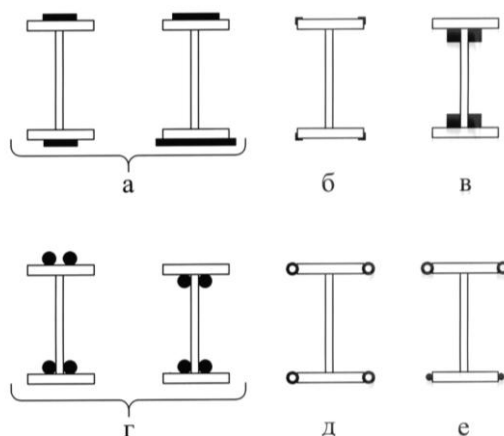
Усиление стальных балок симметричными накладками из: а – полосовой стали; б – уголков; в – квадрата; г – круглой стали; д – труб; е – комбинацией проката
